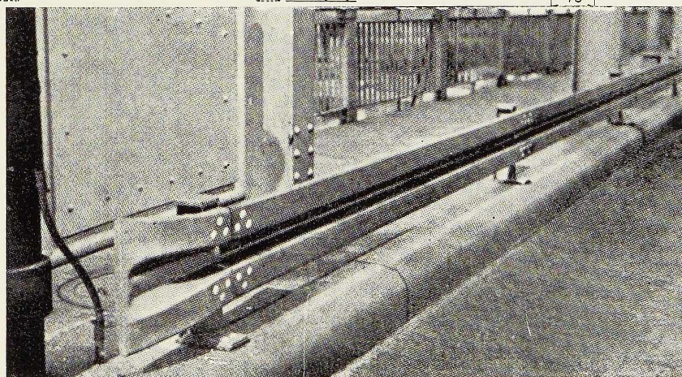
Autre application intéressante, cette barrière protège aussi bien l'utilisateur de la chaussée que le piéton empruntant le trottoir de ce pont.
